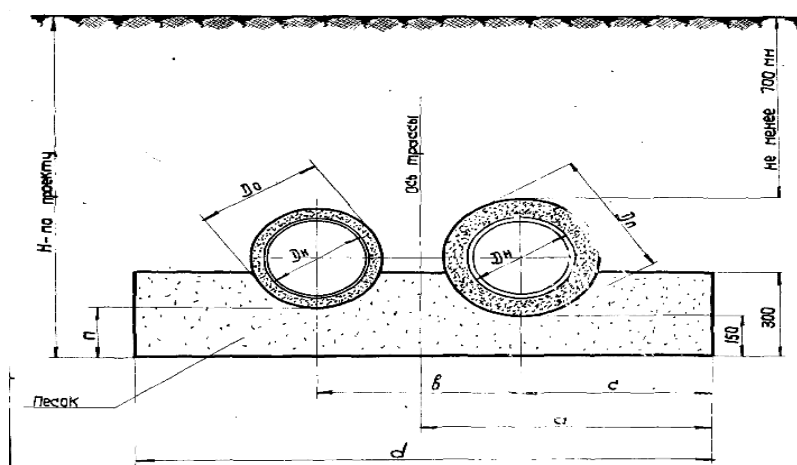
Конструкция бесканальной прокладки тепловых сетей для различных видов изоляции
